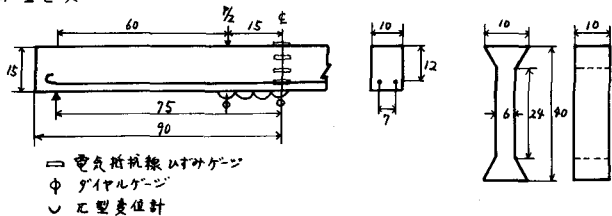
はり試験体およびコンクリートの引張試験用試験体の形状寸法 (cm)
